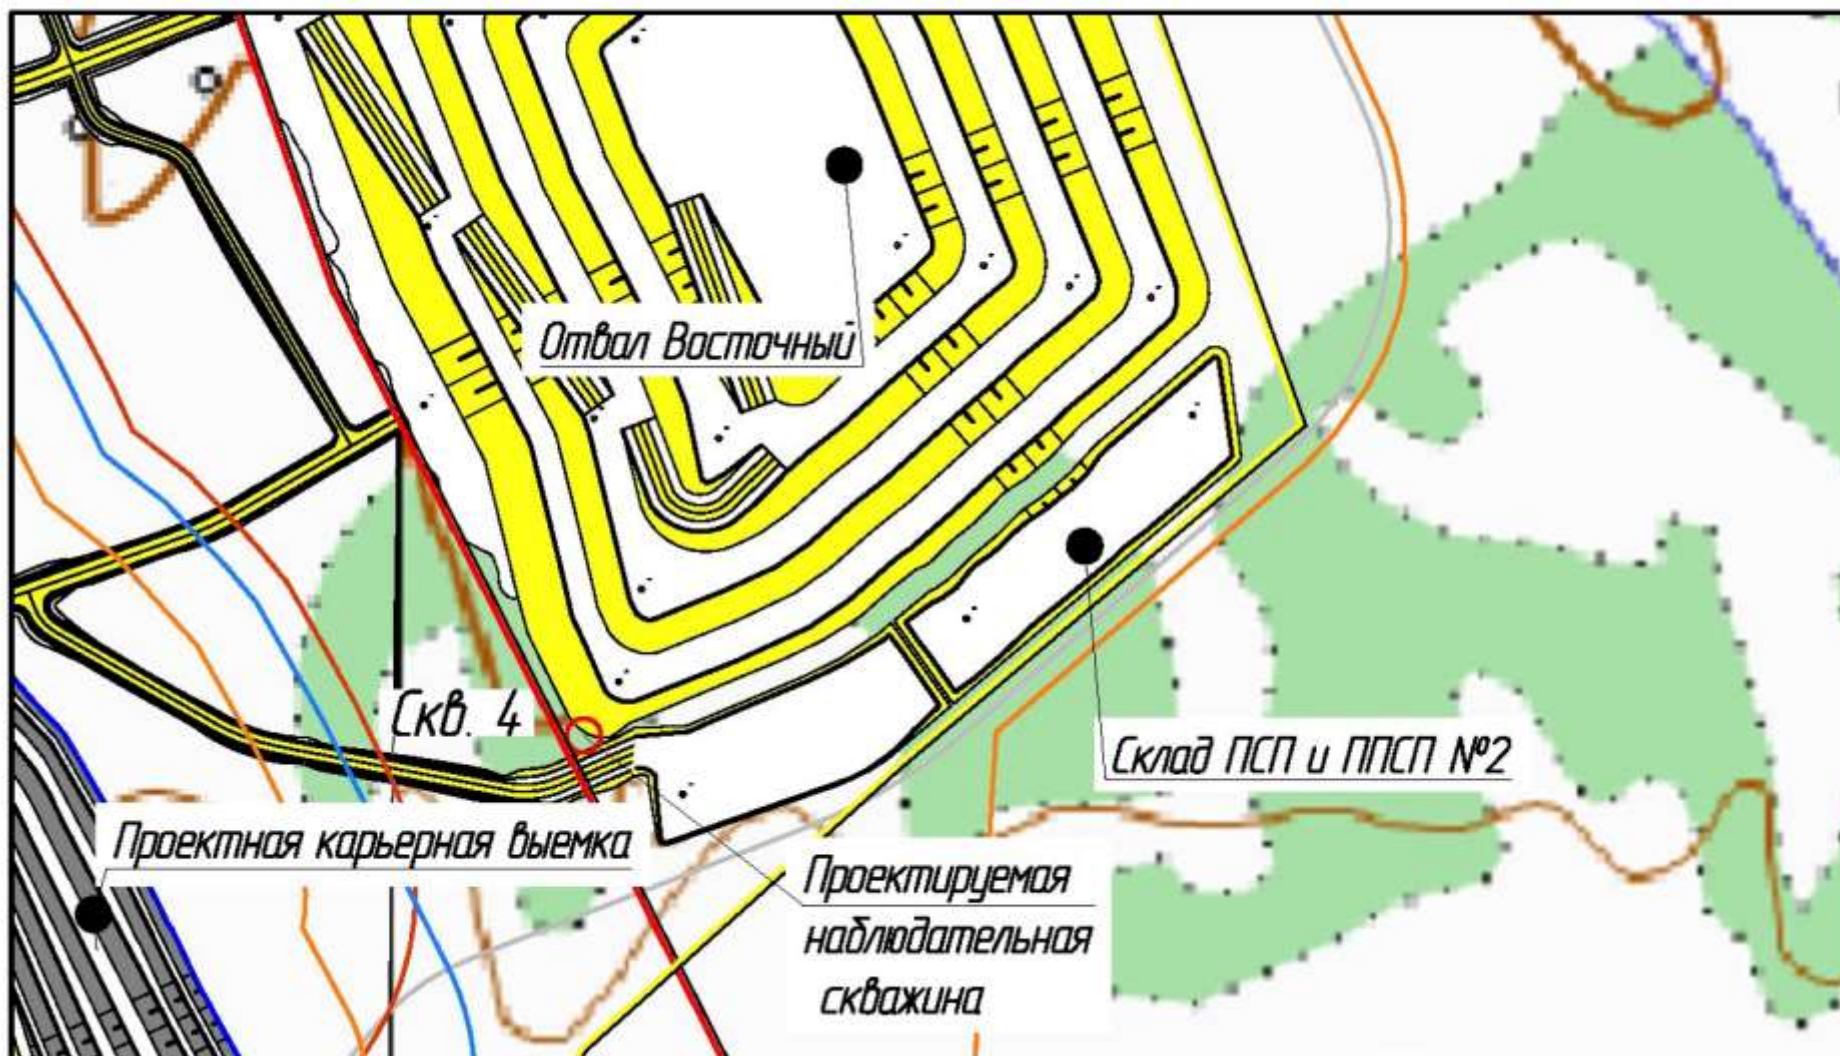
План расположения проектной наблюдательной скважины № 4. Масштаб 1:10000
